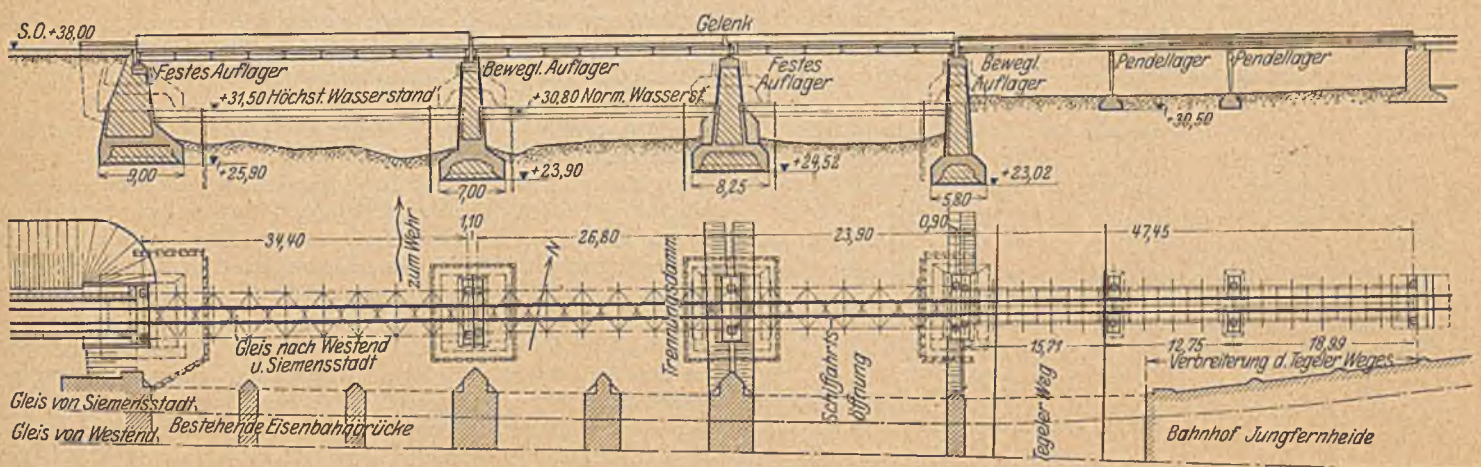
Obere Spreebrücke. Längsschnitt, Grundriß.
